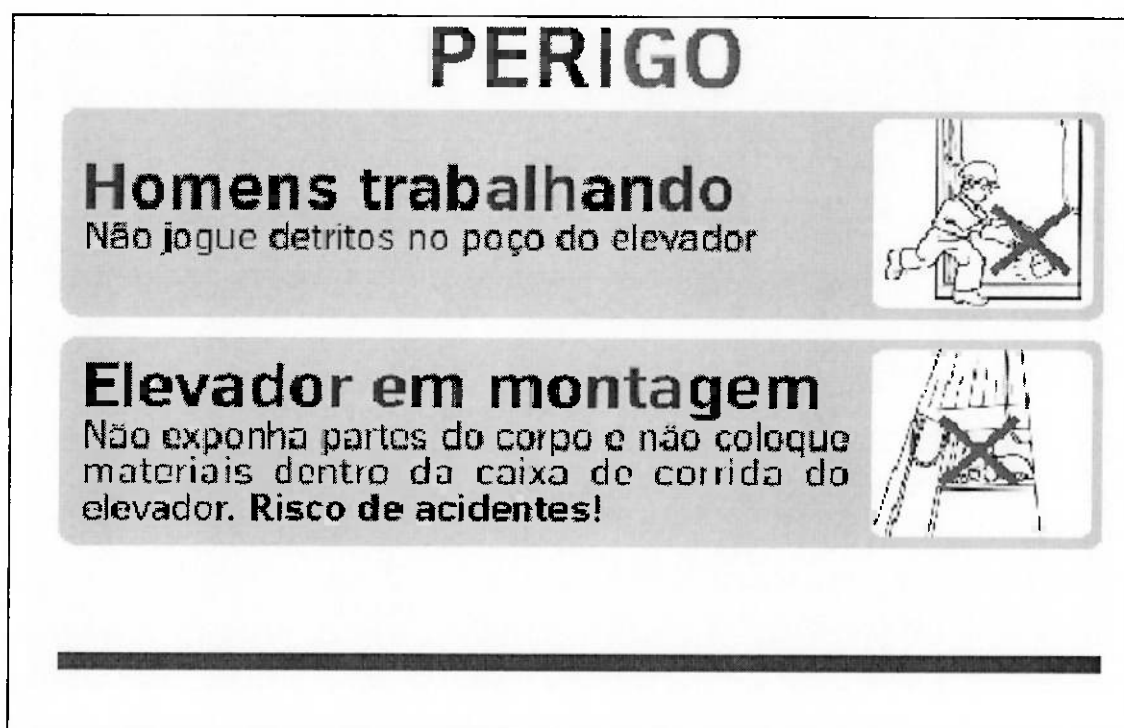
Modelo da sinalização instalada nas proteções de pavimento
